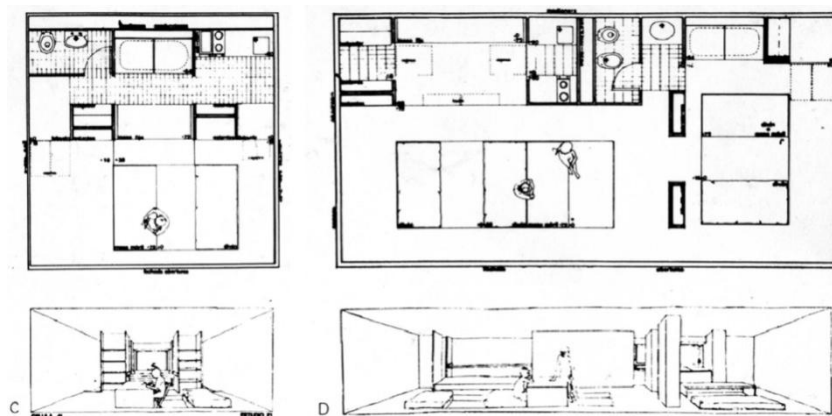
Walden 7, Módulos (planta e corte) - Fonte: Google imagens.
